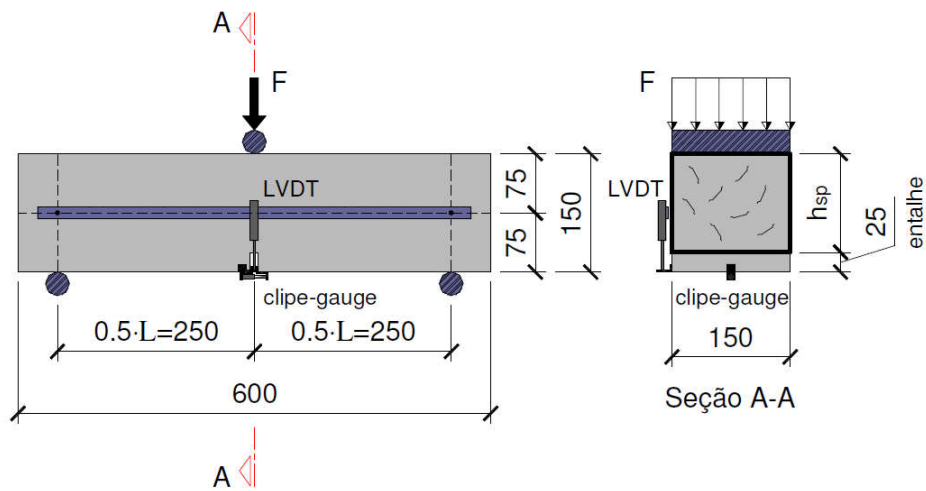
Esquemático do ensaio de tração por flexão (RILEM TC 162-TDF, 2002).
